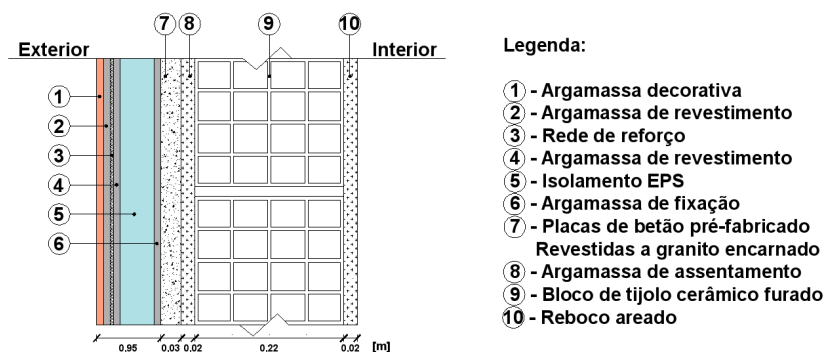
Pormenor da parede exterior, com a aplicação do isolamento térmico exterior
